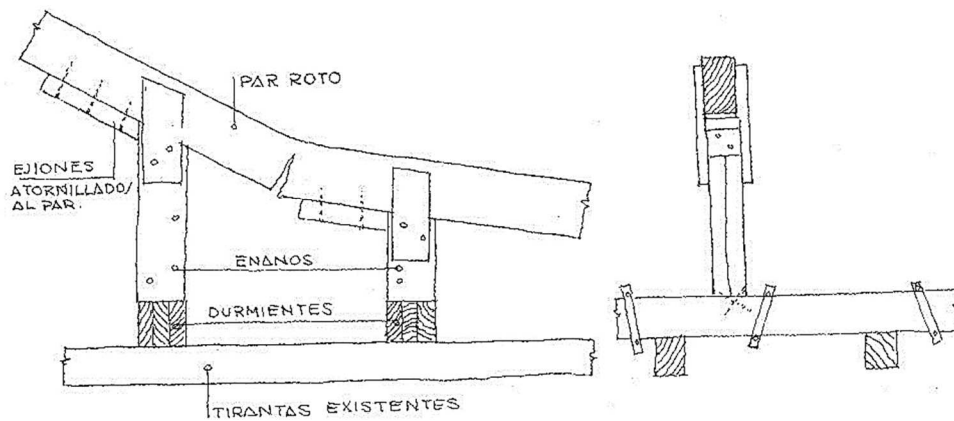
Solución mediante apoyo en viguetas inferiores
